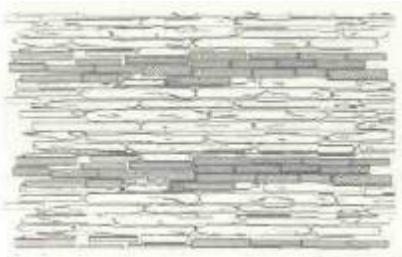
Medea (Zuccaro – Papa): pietra lastriforme (Isola del Piano, PS)
